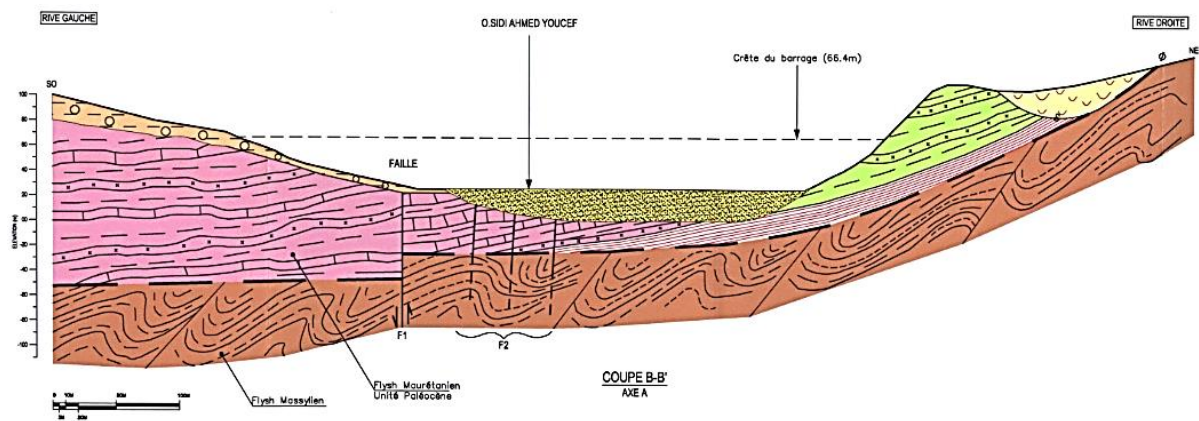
Coupe géologique du site du barrage (la coupe B-B')
